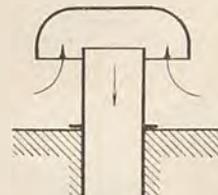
Bocchetta a fungo per aspirazione dal pavimento.
